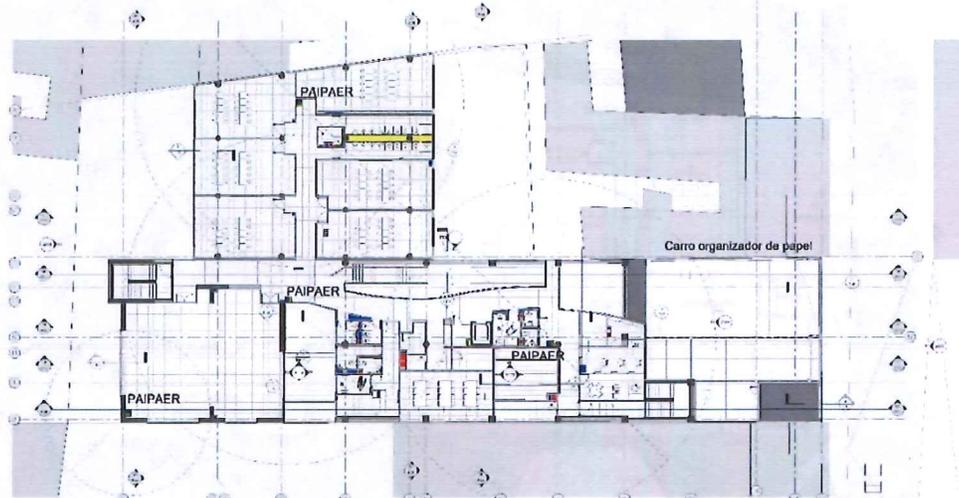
Imagen de planta nivel +3.65 – localización PAIPAERS (anexo No. 9).
